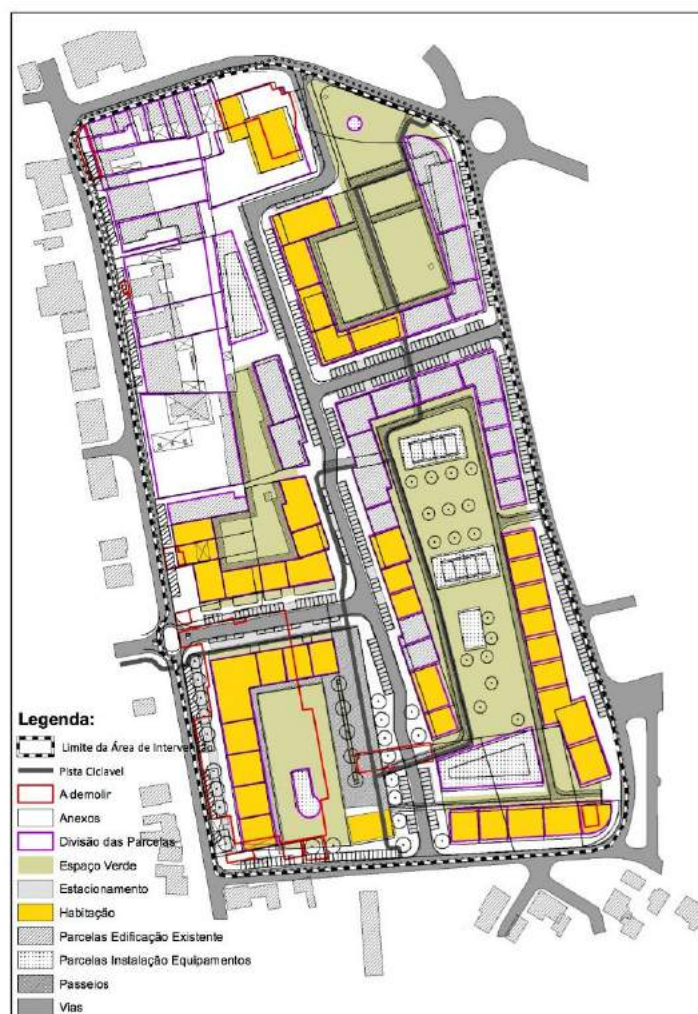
Planta de Implantação do Plano de Pormenor de S. Sebastião
